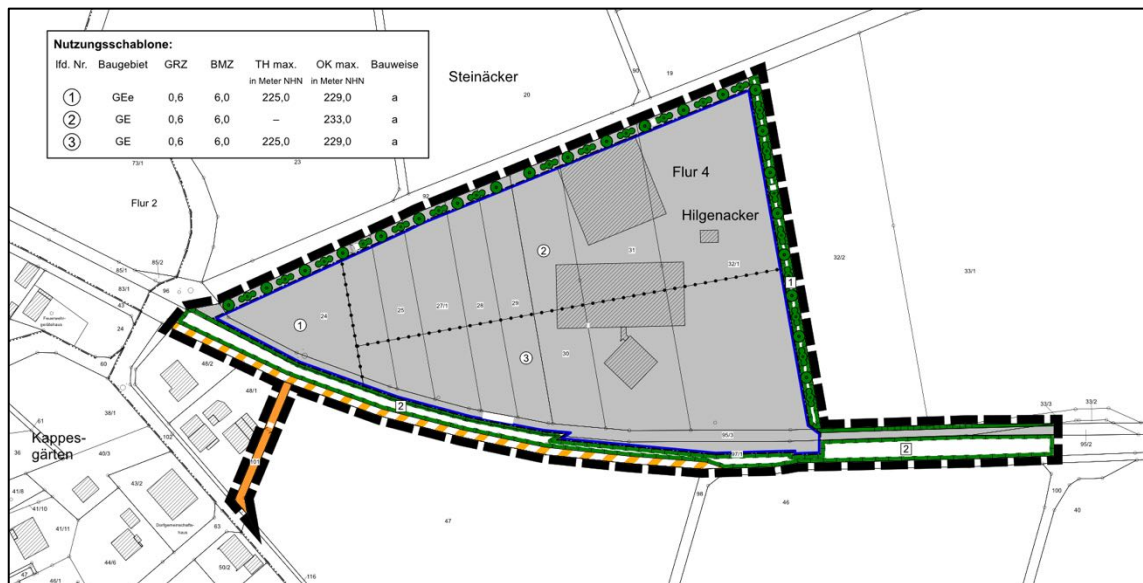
Bebauungsplanvorentwurf - Planteil
